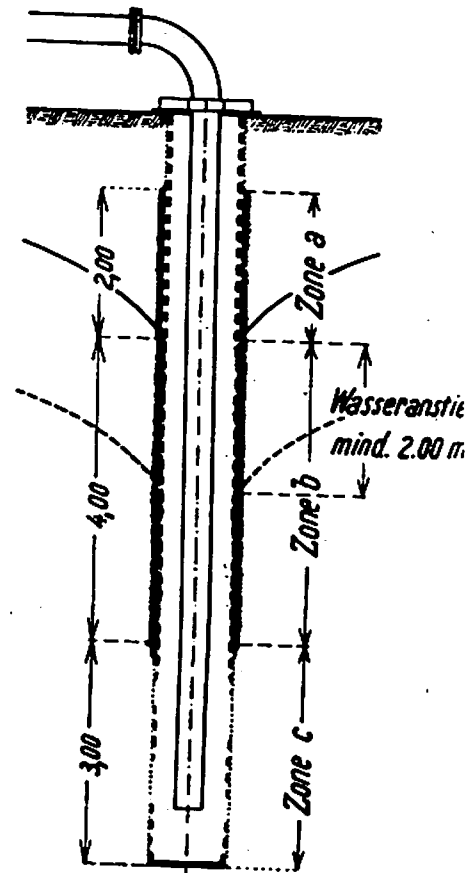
Schema der Zerstörungen und Verkrustungen an Filterbrunnen anlässlich der Grundwasserabsenkung beim Bau der dritten Schleuse in Wemeldinge.
